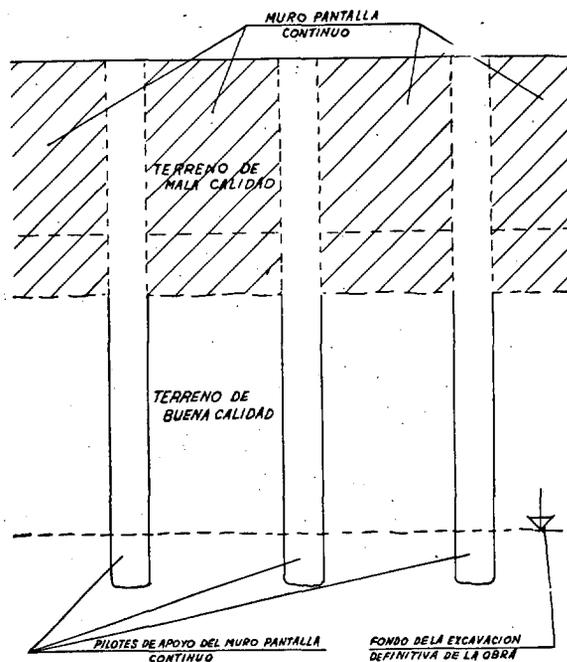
Esquema de la disposición del muro pantalla mixto cimentado sobre pilotes.
